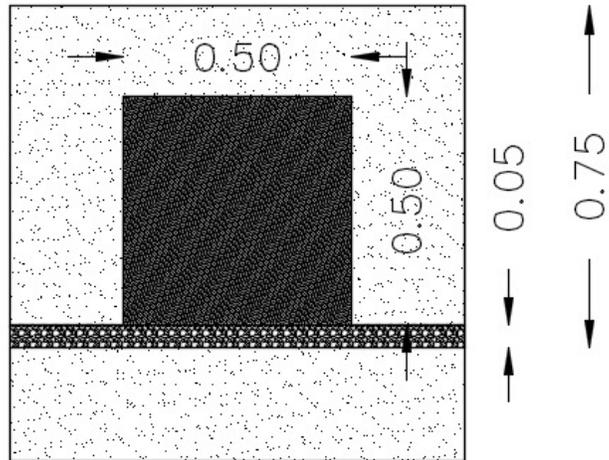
Perfil de la Cimentación encontrada. fuente Propia
